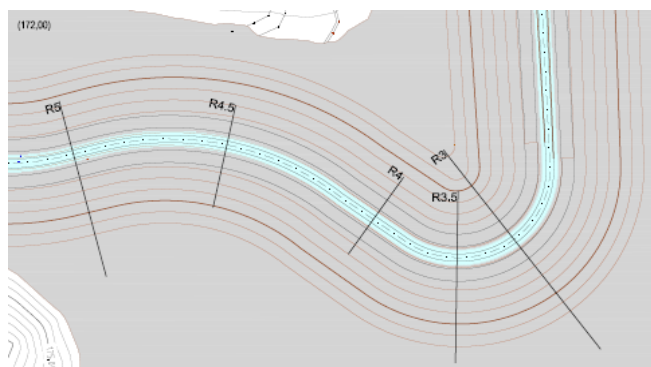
Planta da zona compreendida entre as secções 3.5 e 4.5 do canal 1.
